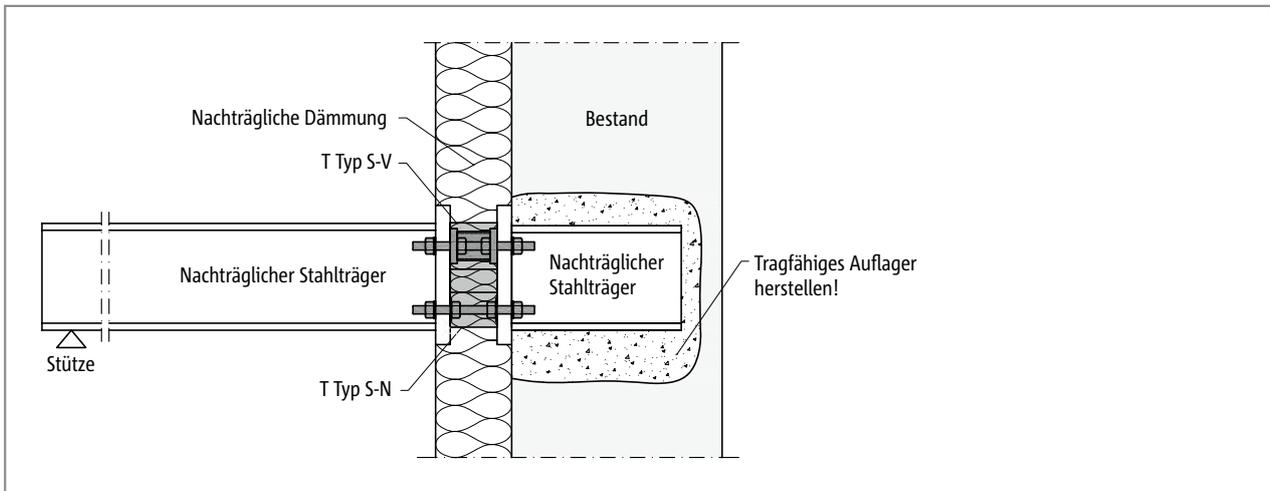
Schöck Isokorb® T Typ S-N und T Typ S-V: Nachträglicher Stahlbalkon gestützt; angeschlossen an nachträglich eingebautes Wandaufleger
